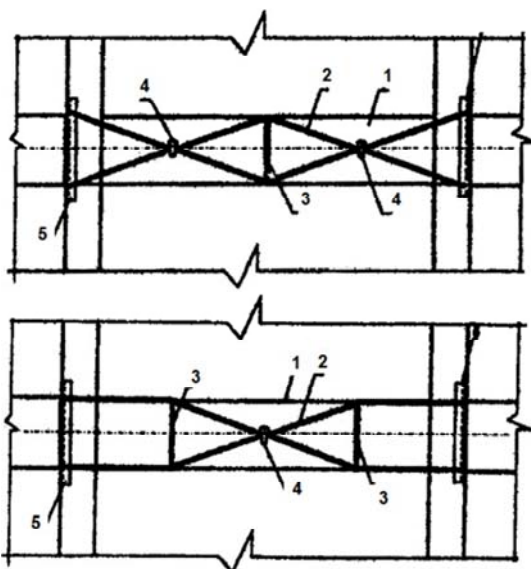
Усиление балки дополнительной предварительно напряженной арматурой с промежуточными распорками:
